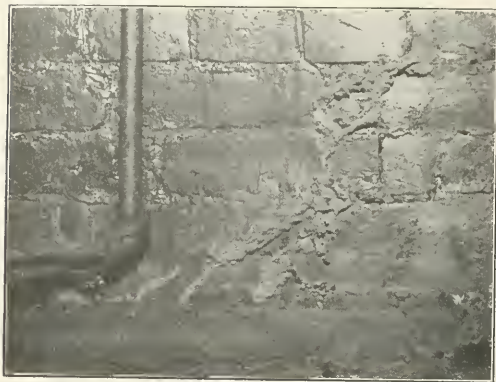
TUBOS ABRIGADEROS DE HORMIGAS BLANCAS. Estos tubos, formados de una mezcla de tierra finamente pulverizada y madera digerida por las hormigas, y contruidos sobre las paredes de ladrillo en los sótanos, pasan por entre las grietas del piso y de los caños de un calefactor. Nótese la estructura granular. Los insectos usan estos tubos para pasar al través de substancias impenetrables, protegiéndose de la luz y extendiendo sus galerías hacia el piso inmediato superior. (En un edificio antiguo en Washington.)
